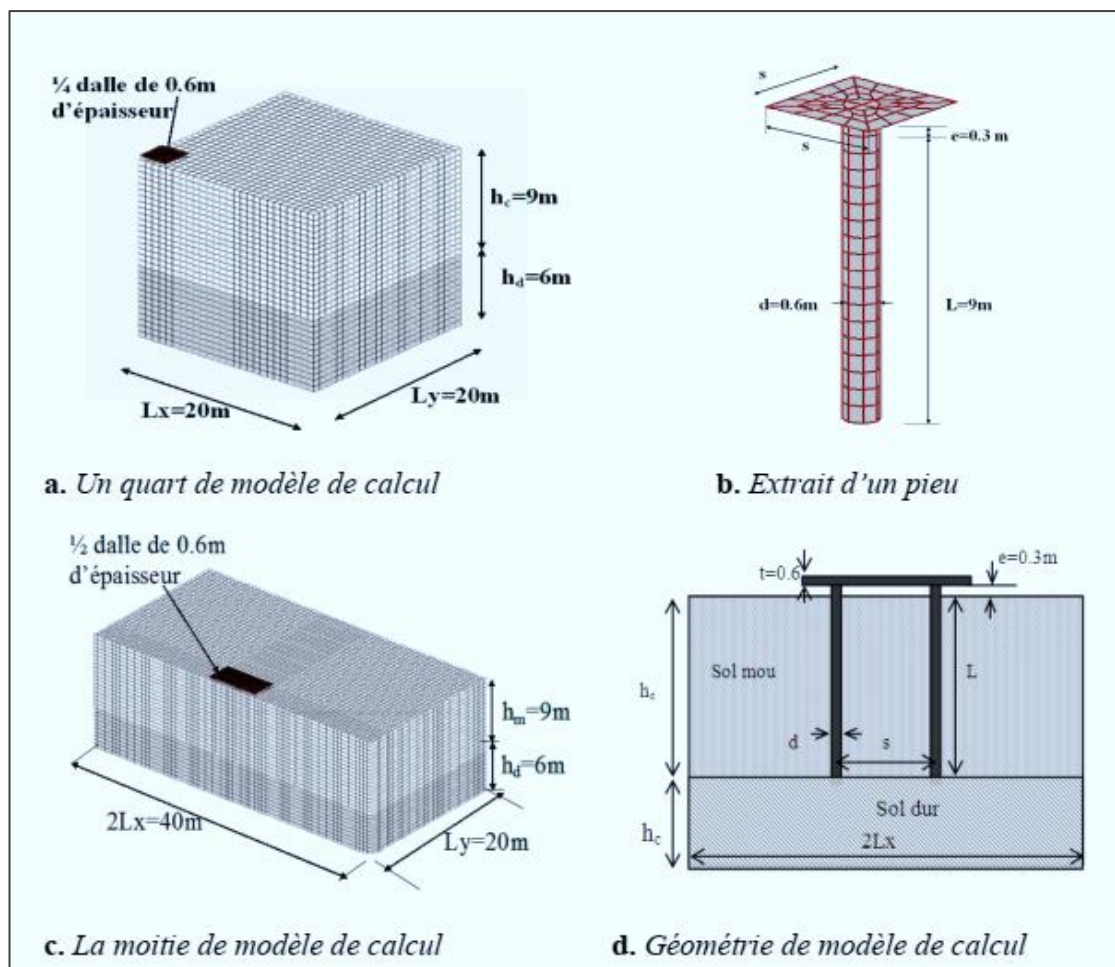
Modélisation de système sol-pieux-dalle (Messioud et al. 2016)
